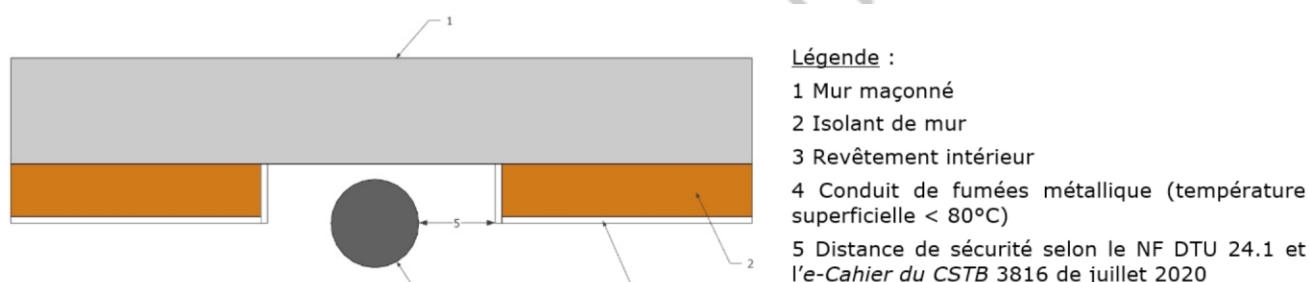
Coupe horizontale de conduit métallique adossant à un mur en zone non habitable ou conduit de raccordement
